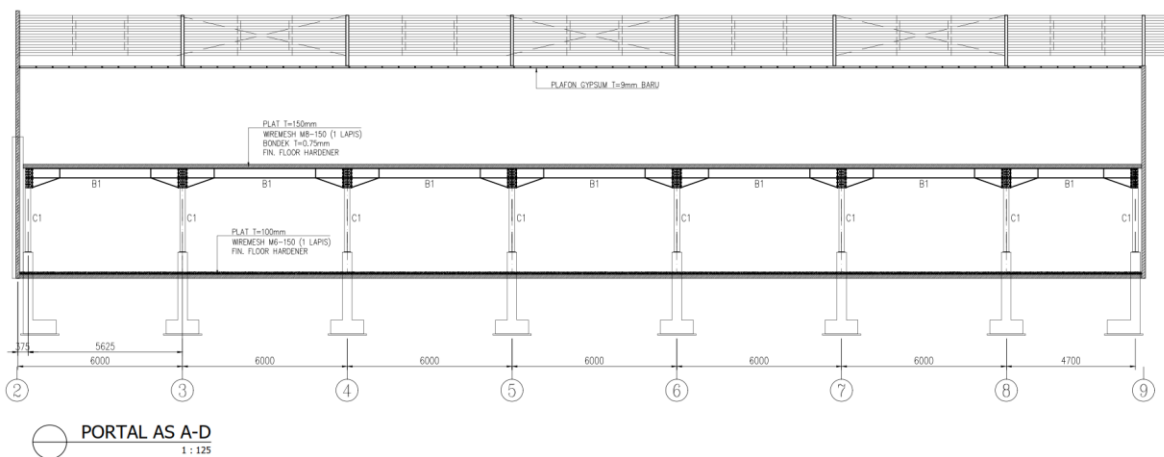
Layout Warehouse Eksisting Lantai 2 (Mezzanine)
